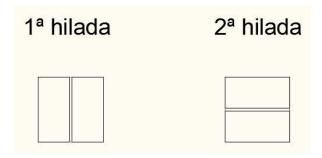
Disposición de las hiladas del pilar según aparejo inglés. Elaboración propia
